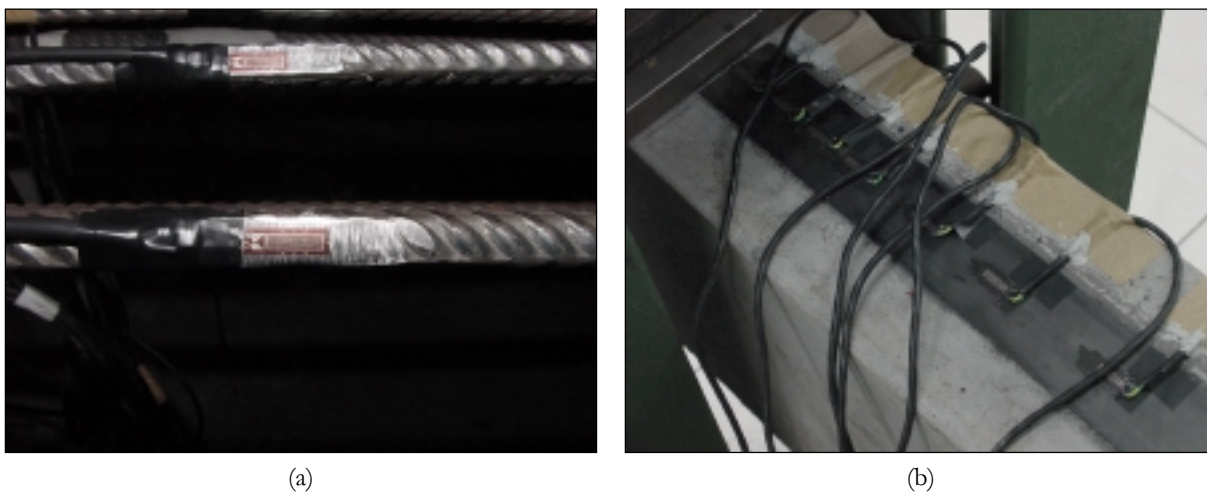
Detalhe da instrumentação da armadura e reforço (grupo F)
